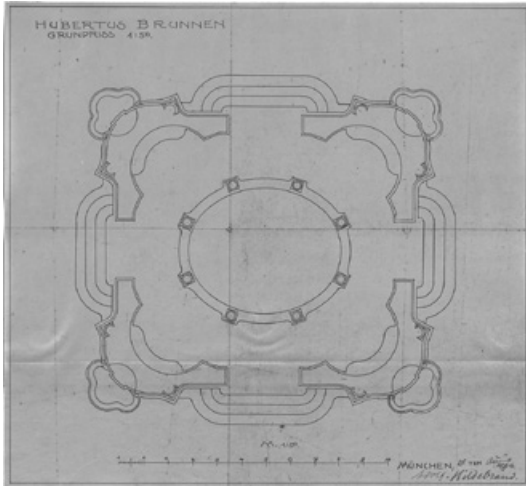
Grundriss (AM, Akt-Nr. hild-244).
